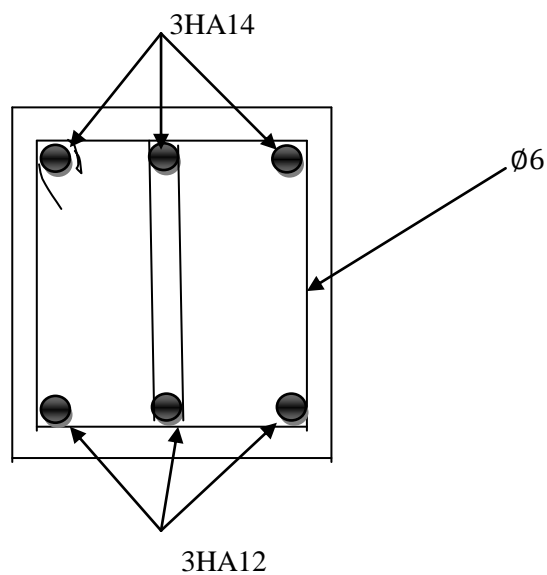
schéma de ferrailage des poutres sens longitudinaux.
